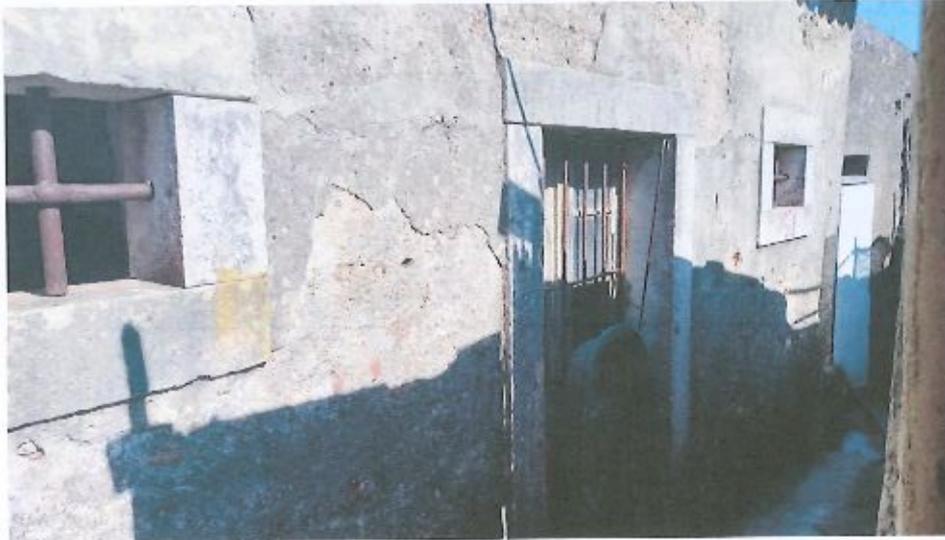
Pormenor da fachada oeste do edifício anexo à cisterna. Vista a partir de NO.
